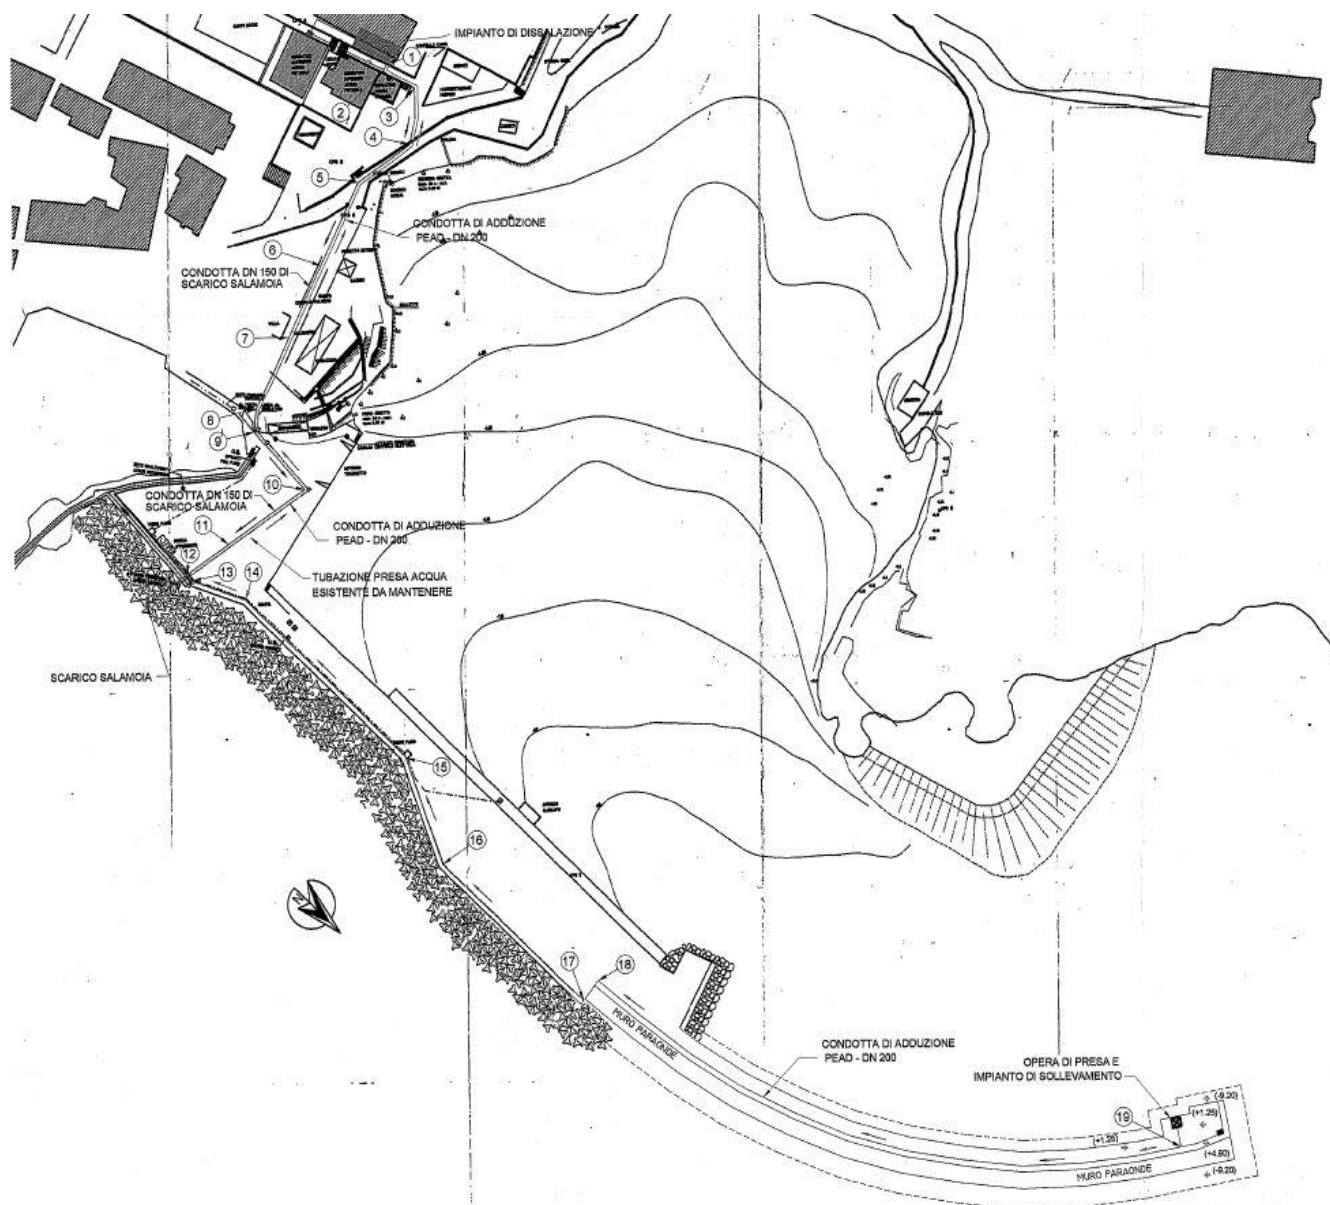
Estratto planimetrico del progetto definitivo approvato in Conferenza dei Servizi con Determinazione dell'Ente proponente (STO ATO4) R.G. n. 1009 del 18/07/2013
